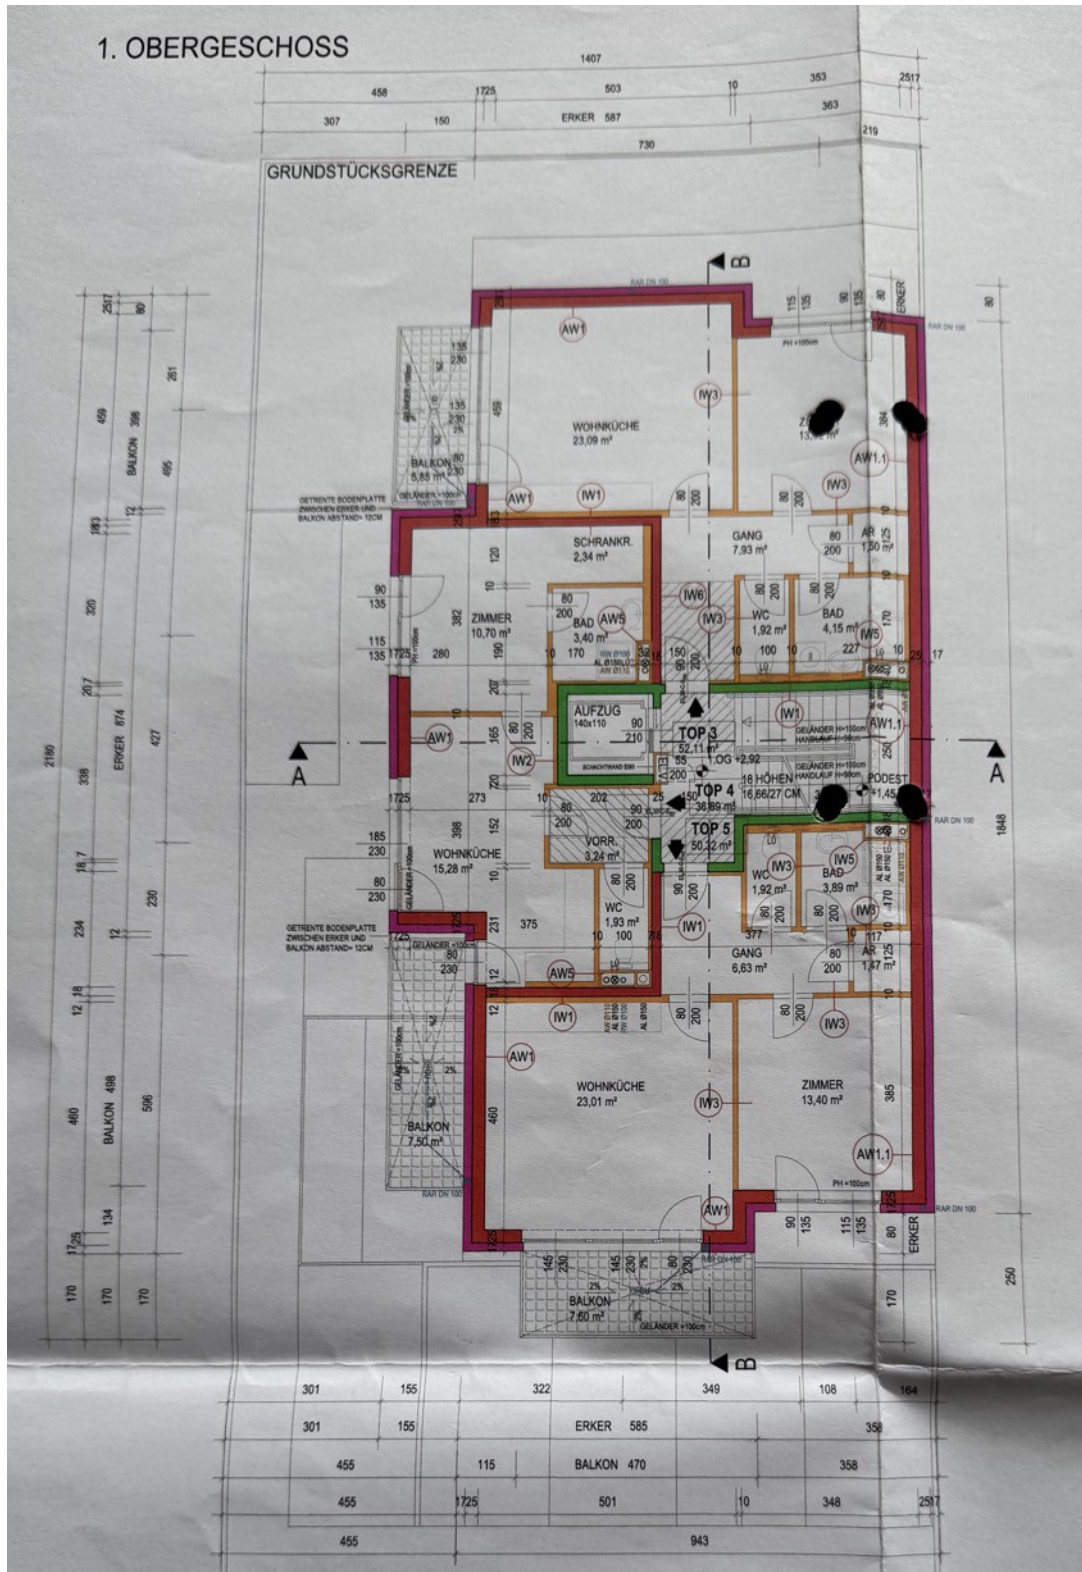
Einreichplan – 1. Obergeschoß / Quelle: auftraggebende Partei
